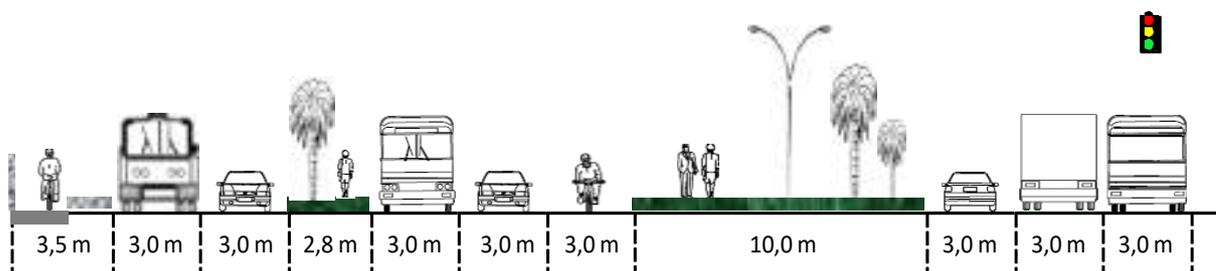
Secção transversal do sistema viário nos pontos de amostragem.
